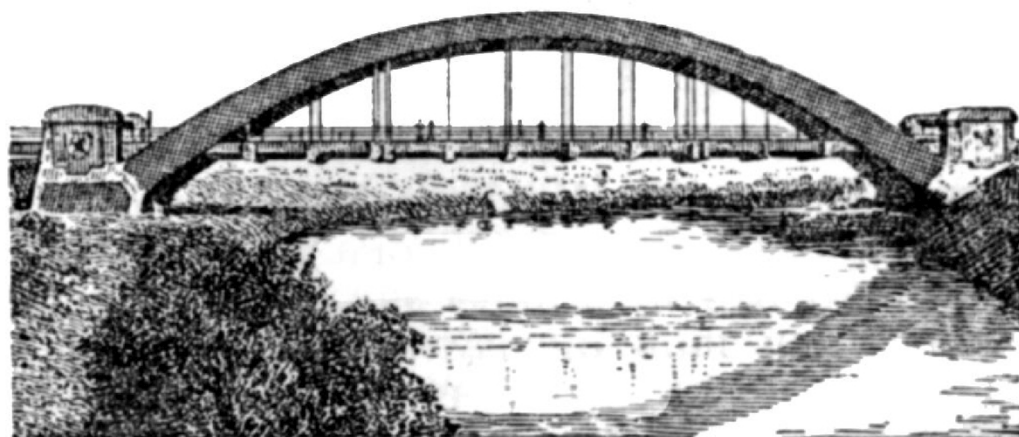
Мост с железобетонными арочными перекрытиями над ездовым полотном
